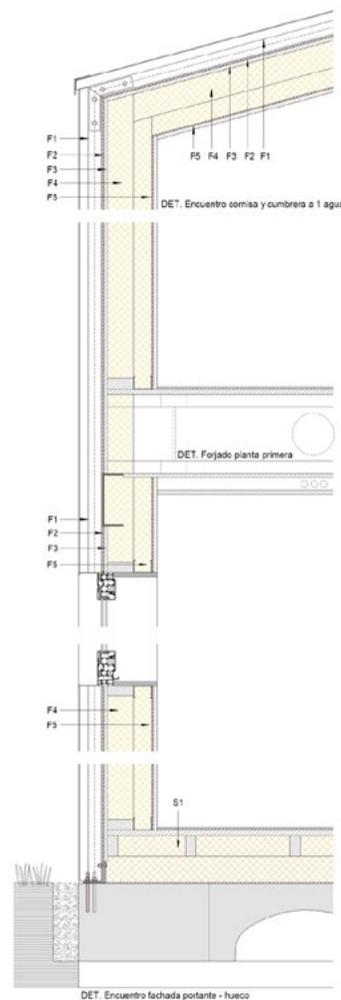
Det. Constructivo Encuentro fachada portante-hueco.
